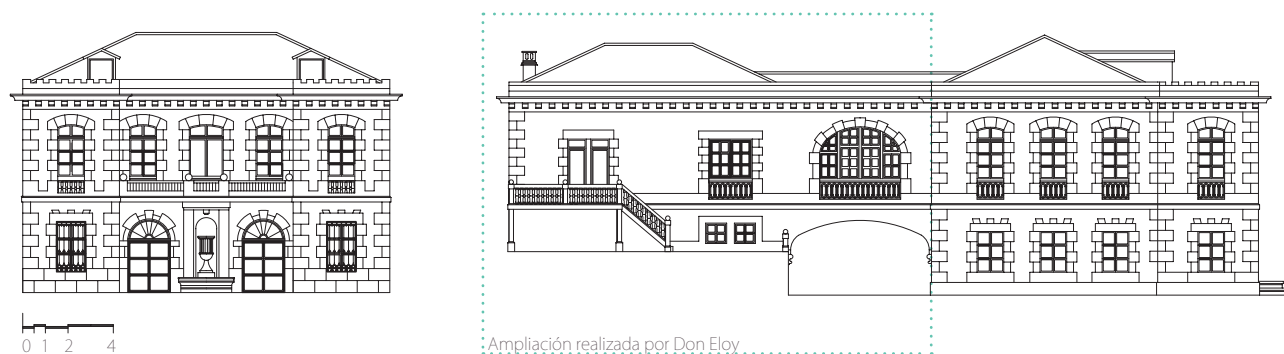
Alzado Principal y Alzado lateral derecho de Villa María tras su ampliación
